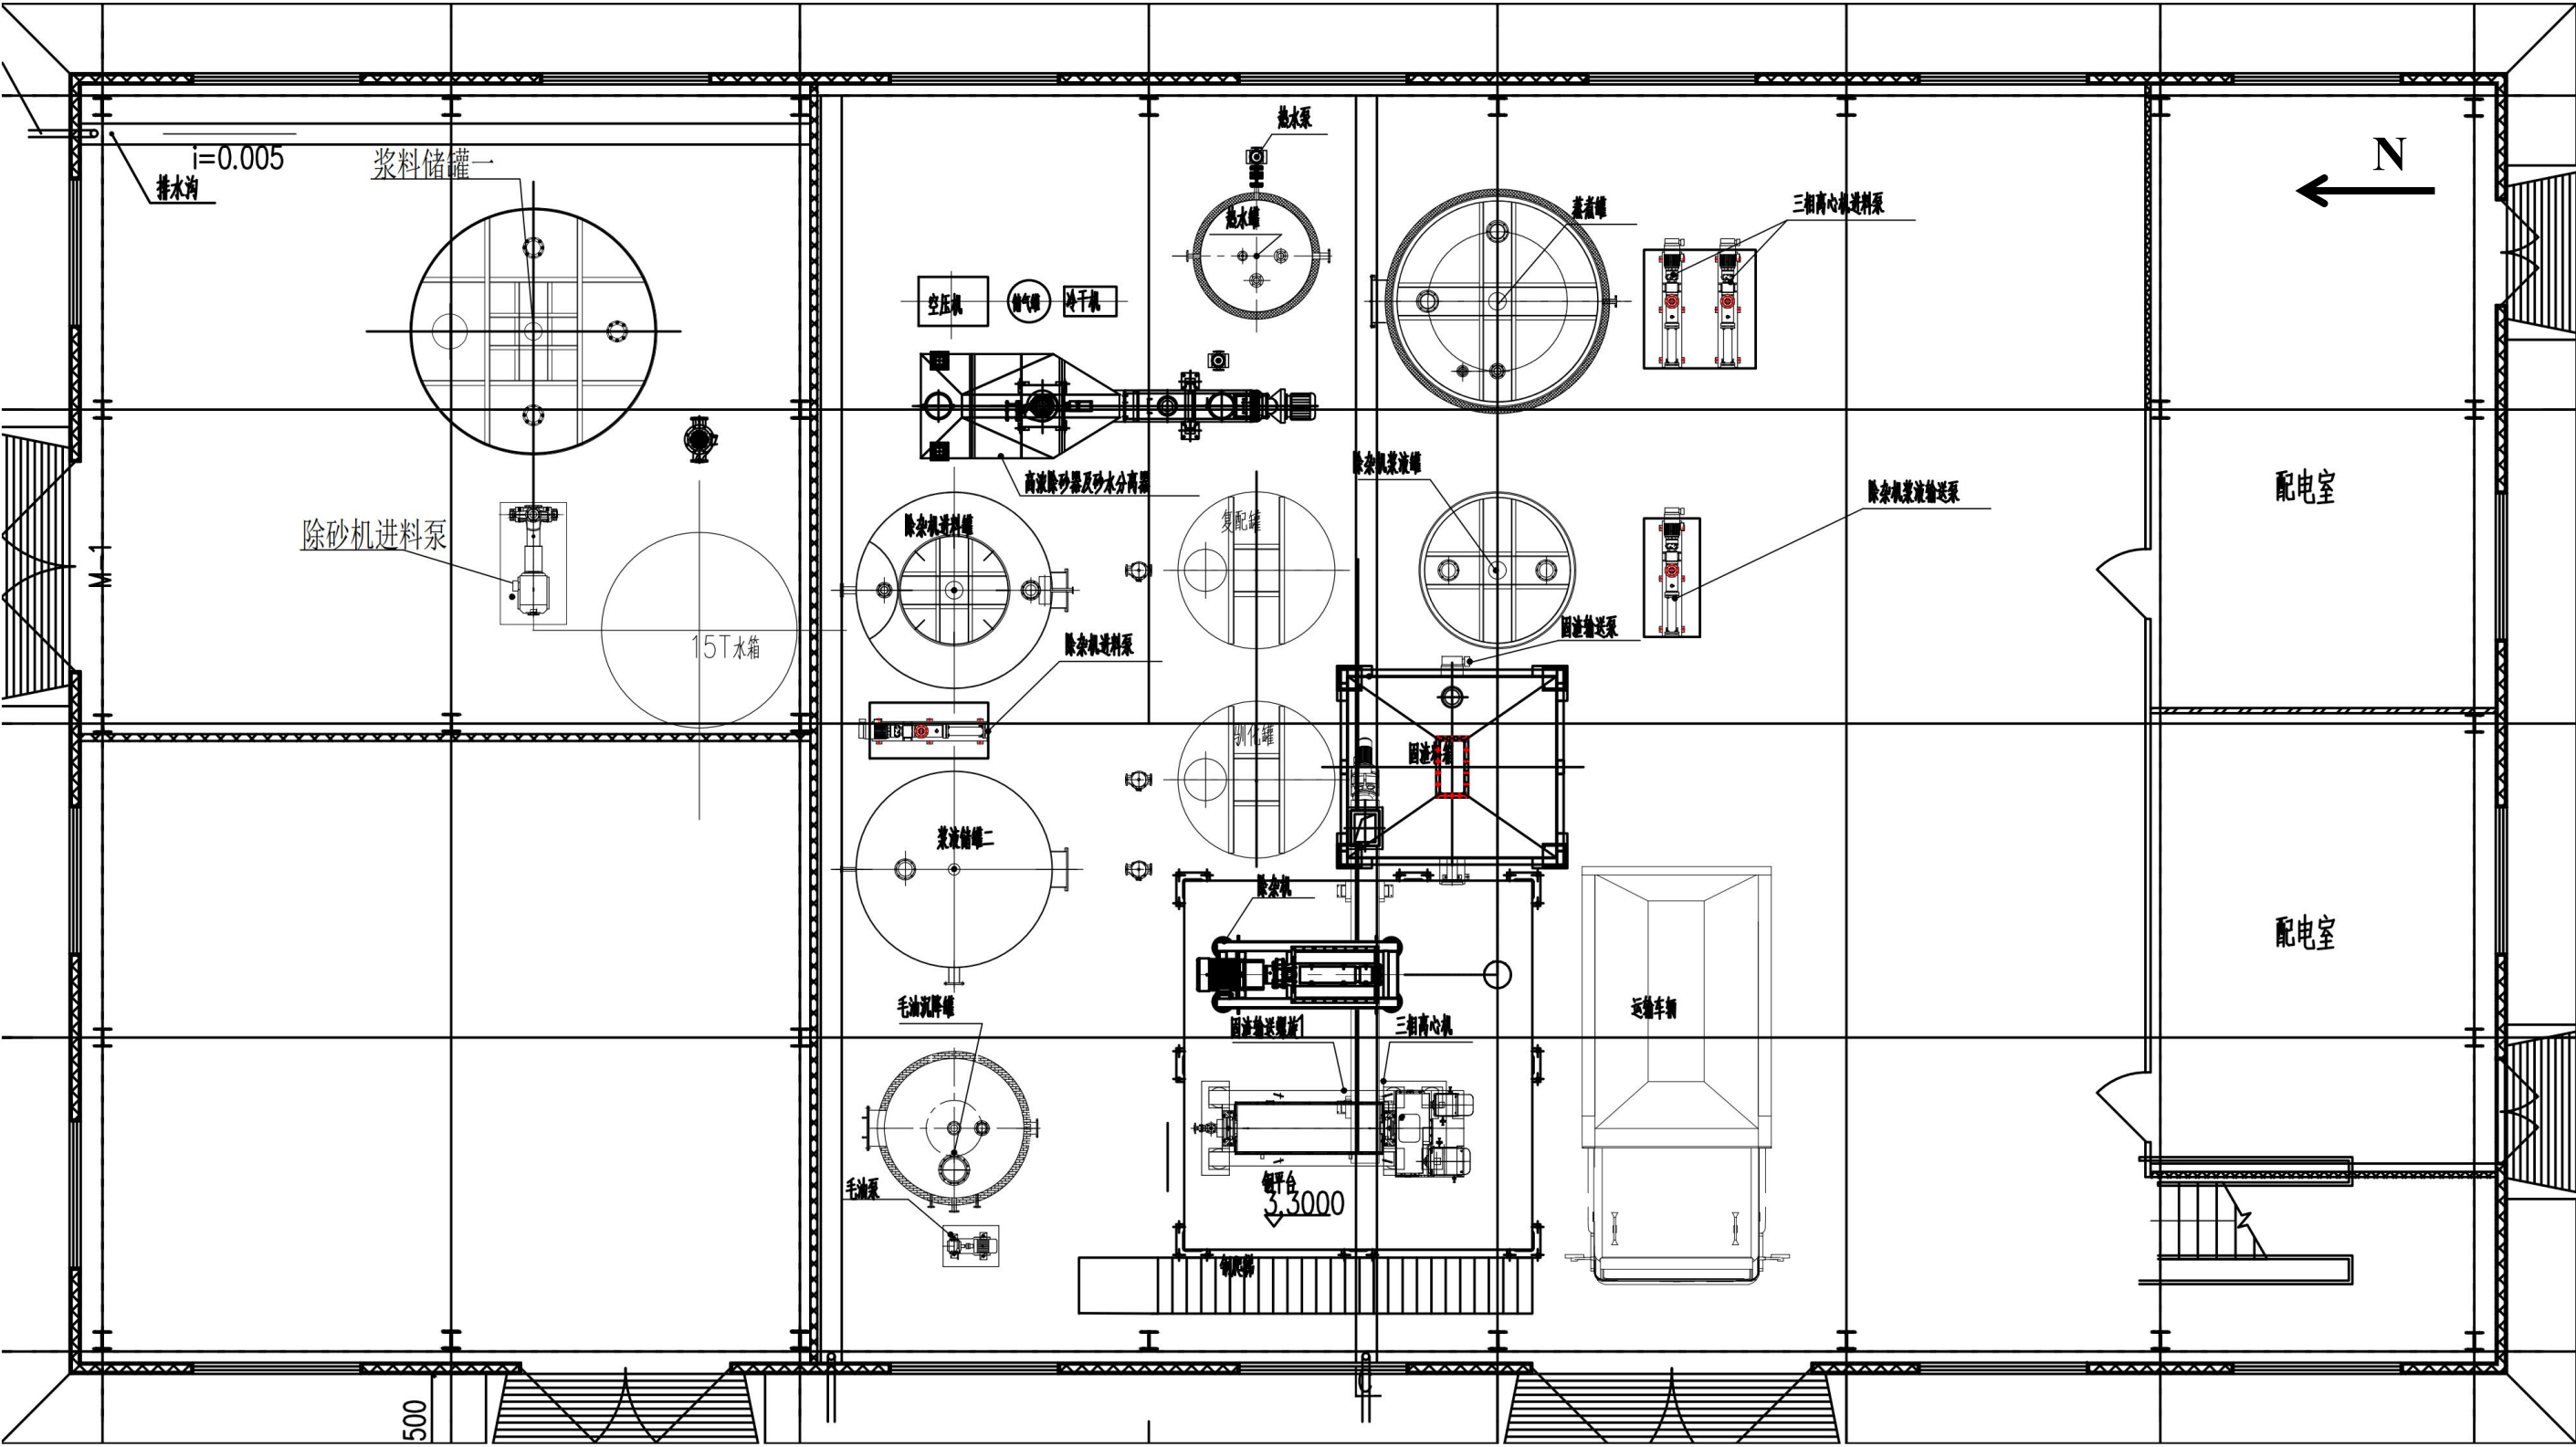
本项目餐厨废弃物处理车间平面布置图
